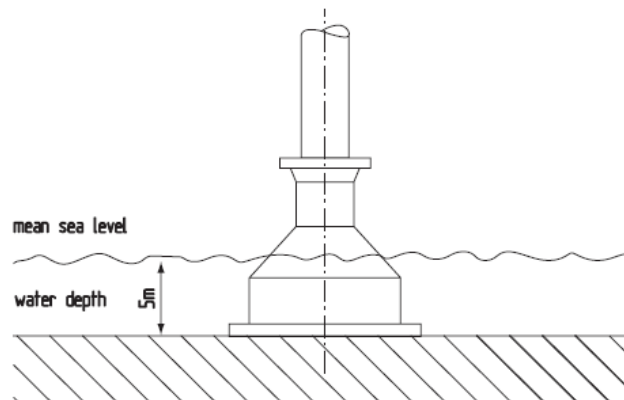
CIMENTACIÓN POR GRAVEDAD
